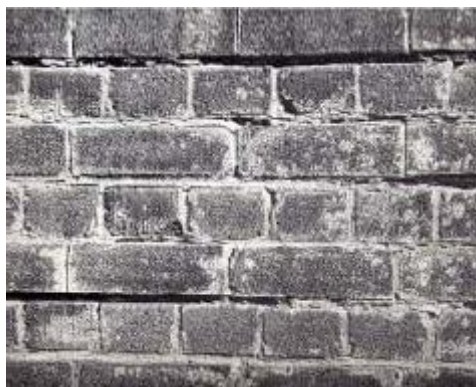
Fissuras horizontais nas juntas de argamassas causadas por reações químicas (Fonte:ELDRIDGE)
